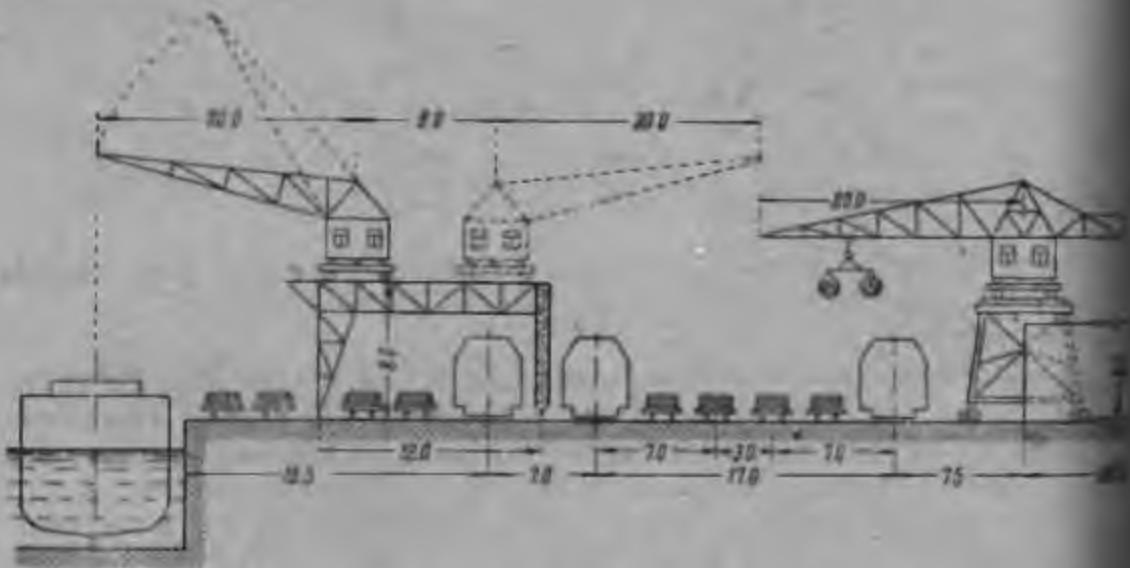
Схема оборудования для погрузки круглого леса посредством порталовых кранов у причала и катучих кранов на складе.
